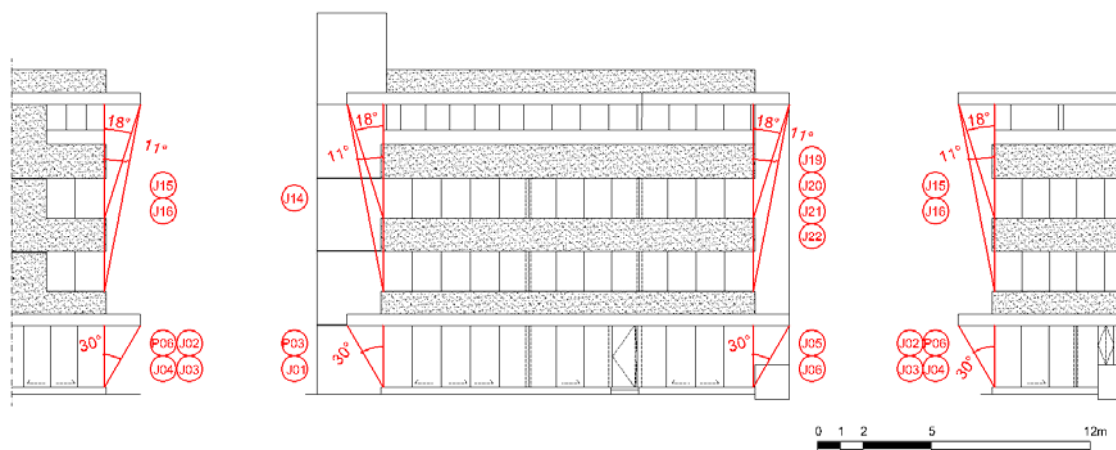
Ângulos Verticais de Sombreamento (AVS) indicados nas fachadas Leste, Norte e Oeste
